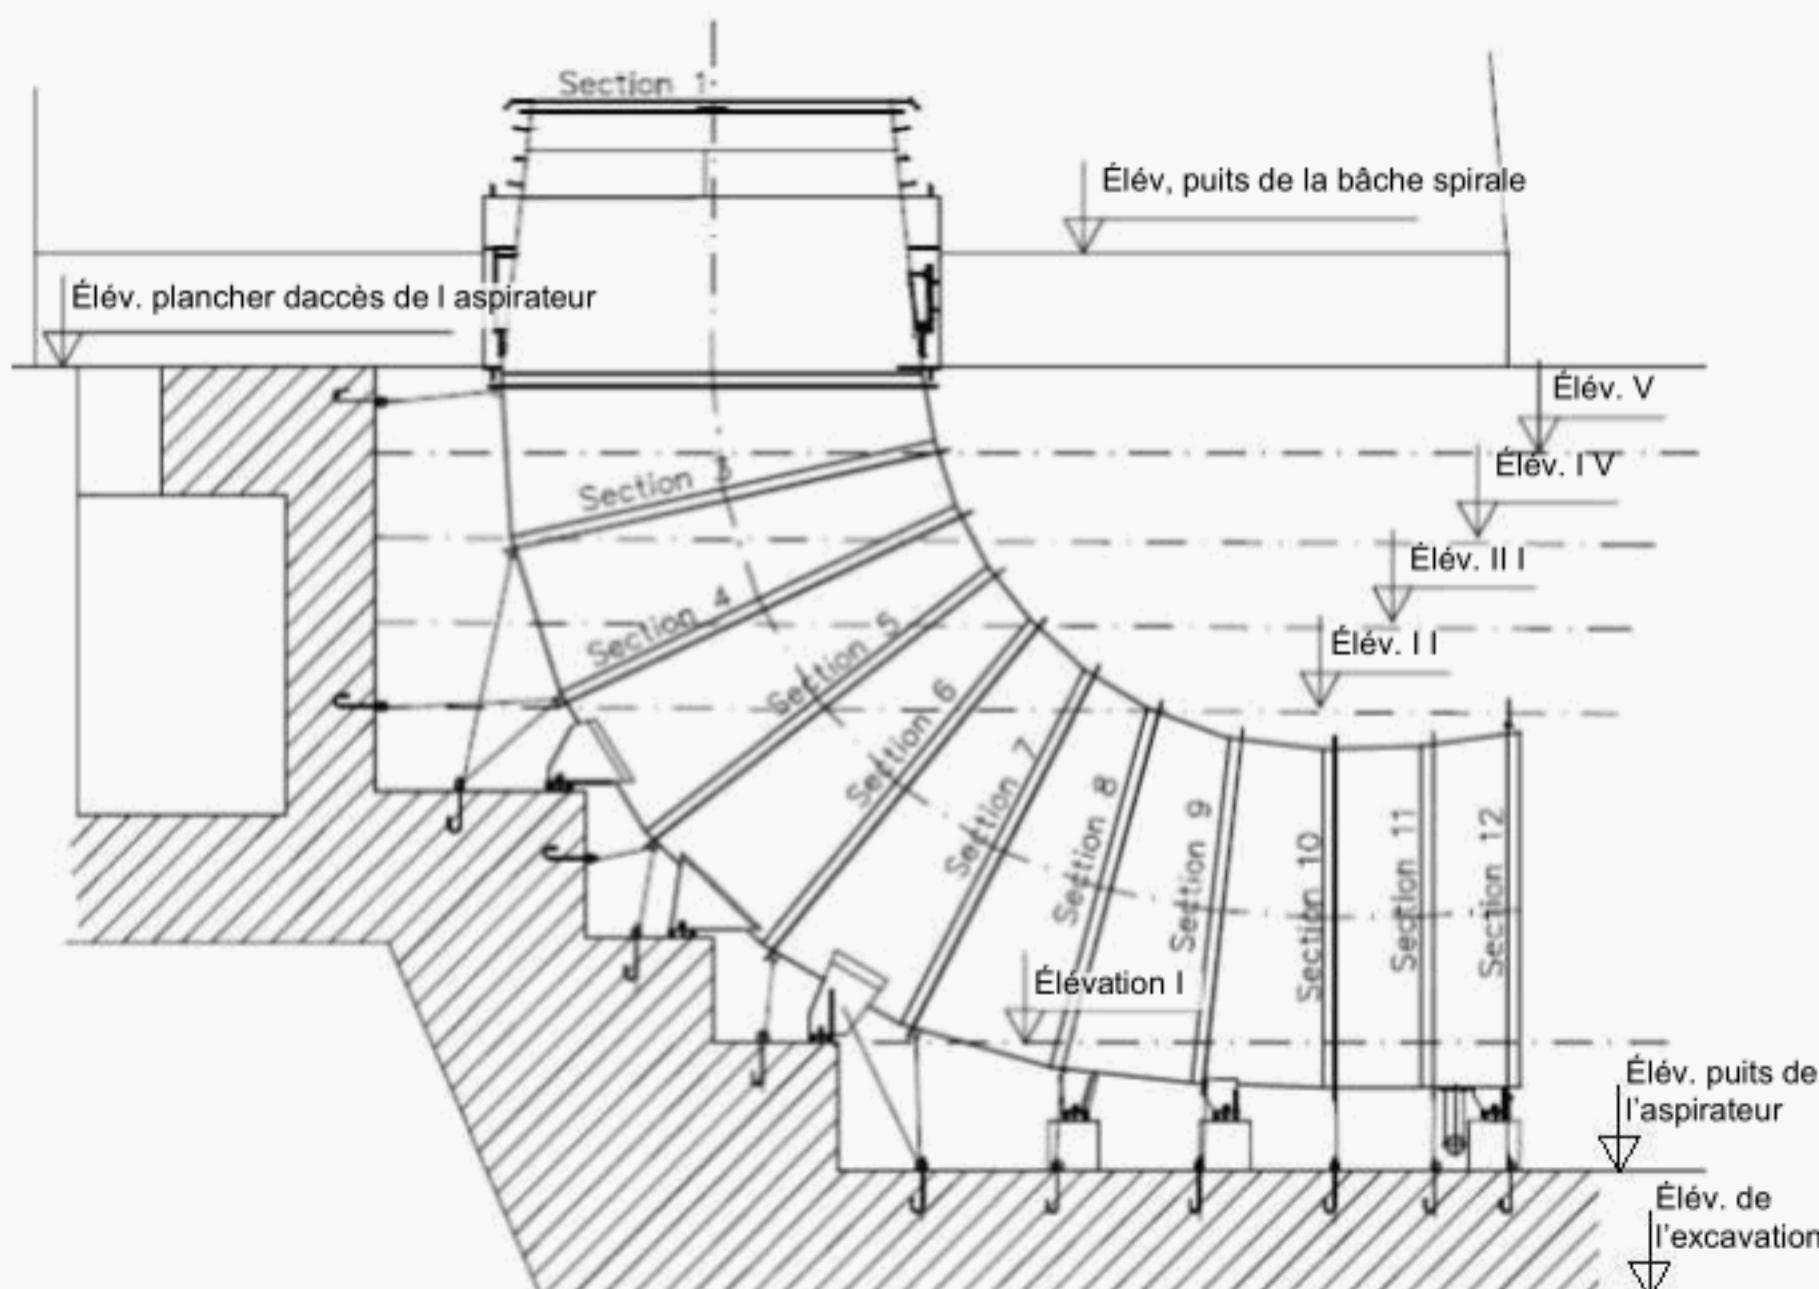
Plan de bétonnage du blindage de l'aspirateur
